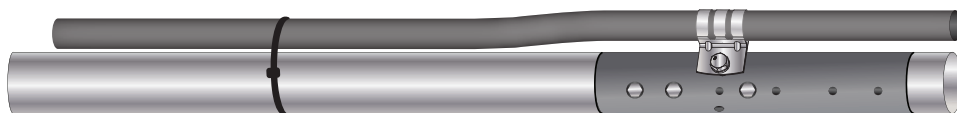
Fissare il conduttore alla sezione inferiore del palo come necessario
